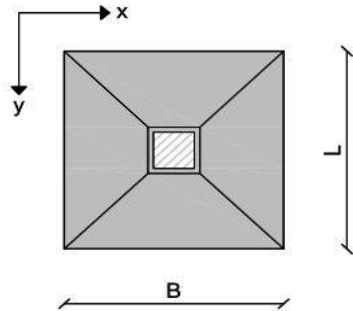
Fig. A - Disposizione planimetrica generica dei plinti oggetto delle verifiche
